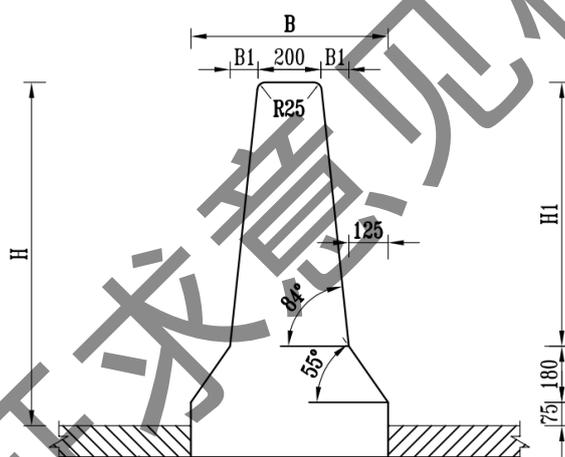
F 型中央分隔带玻璃纤维钢筋混凝土护栏 (尺寸单位: cm)
